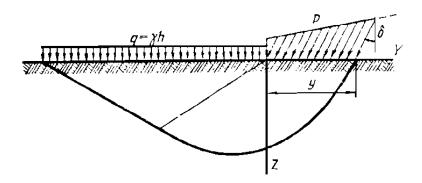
Схема действия наклонной нагрузки на грунт
